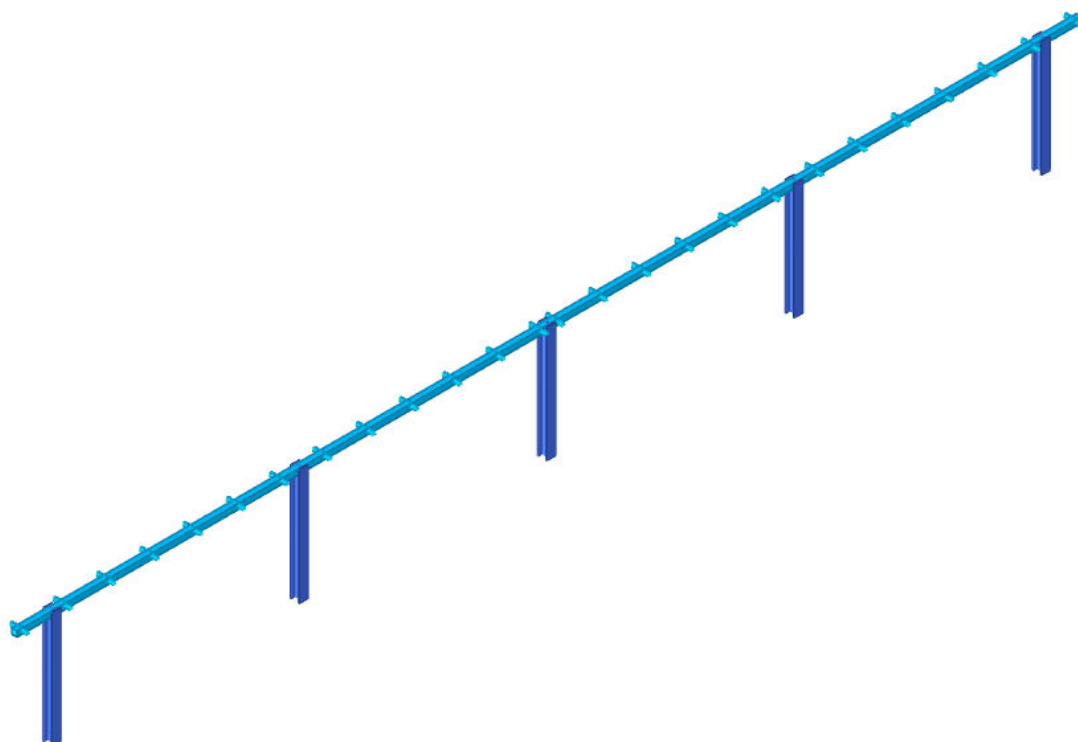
Vista assonometrica modello strutturale con posizione della "vela" orizzontale
